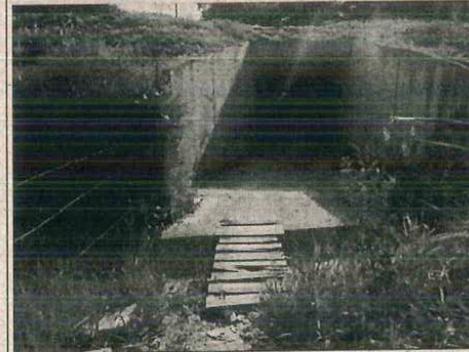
Adequar entrada da passagem de fauna situada no km 49+350 (implantar passarela de concreto). Vão formado por sistema de drenagem dificulta ou não permite a entrada de animais. A ponte de madeira é uma medida temporária.
